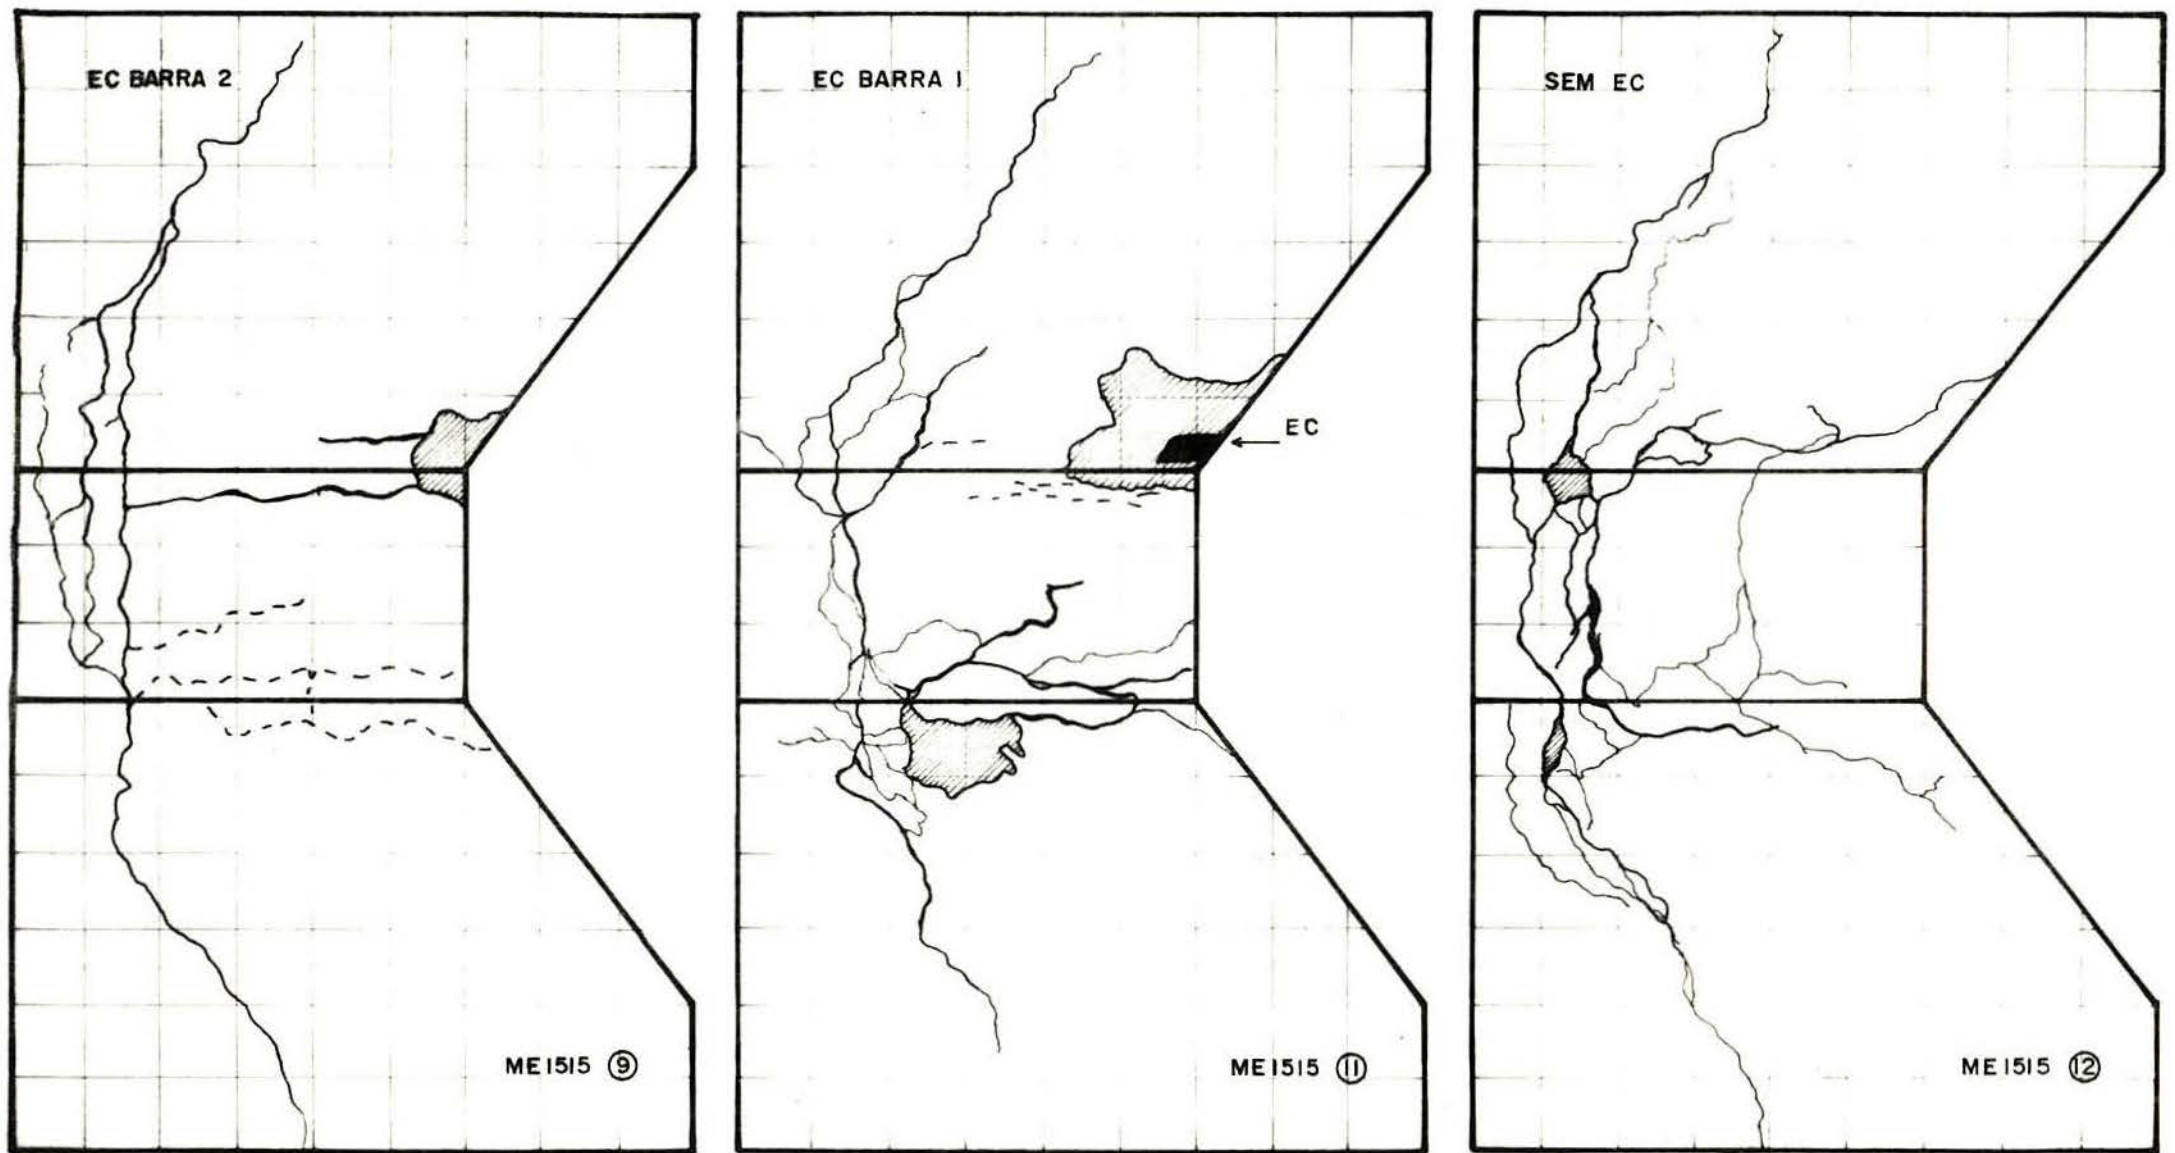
Fissuração dos CP ME1515
